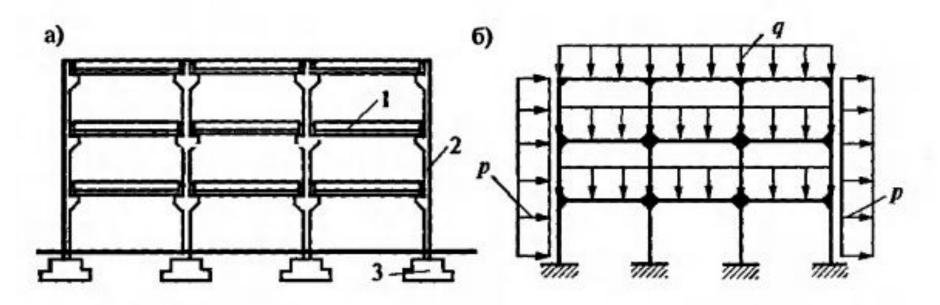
Рамная схема каркаса: а) конструктивная схема; б) расчетная схема; 1— неразрезанный ригель; 2— колонна; 3— фундамент
